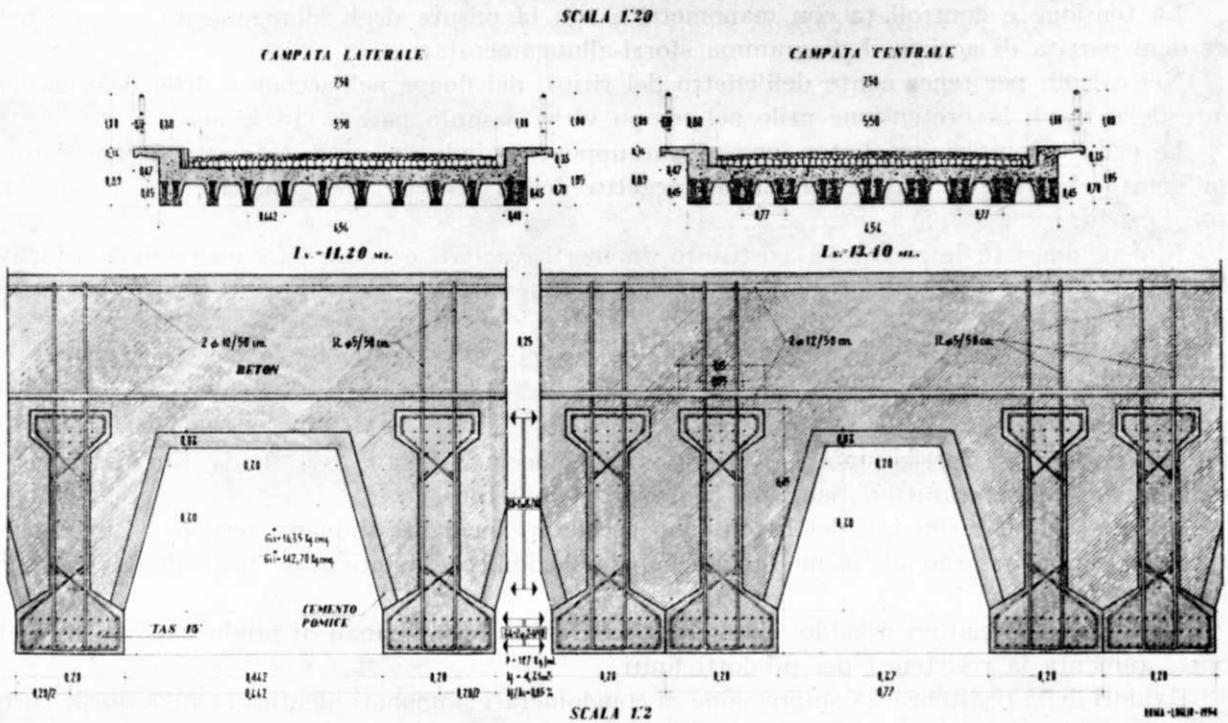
Sezioni e dettagli del ponte S. Isidoro con T.A.S. profilo 45.
